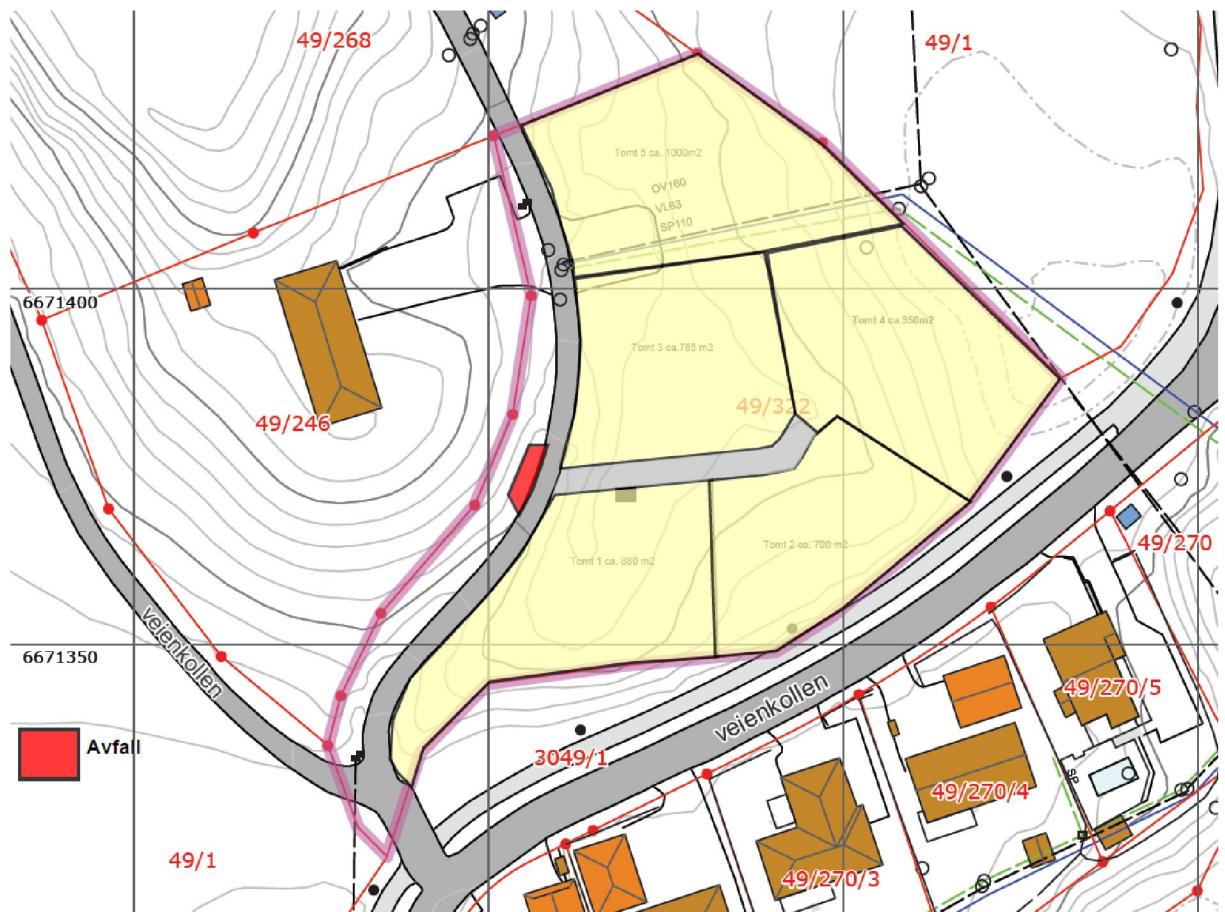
Bredbånd ved Veienkollen boligfelt – koblingskap står rett på grensen til planområdet
